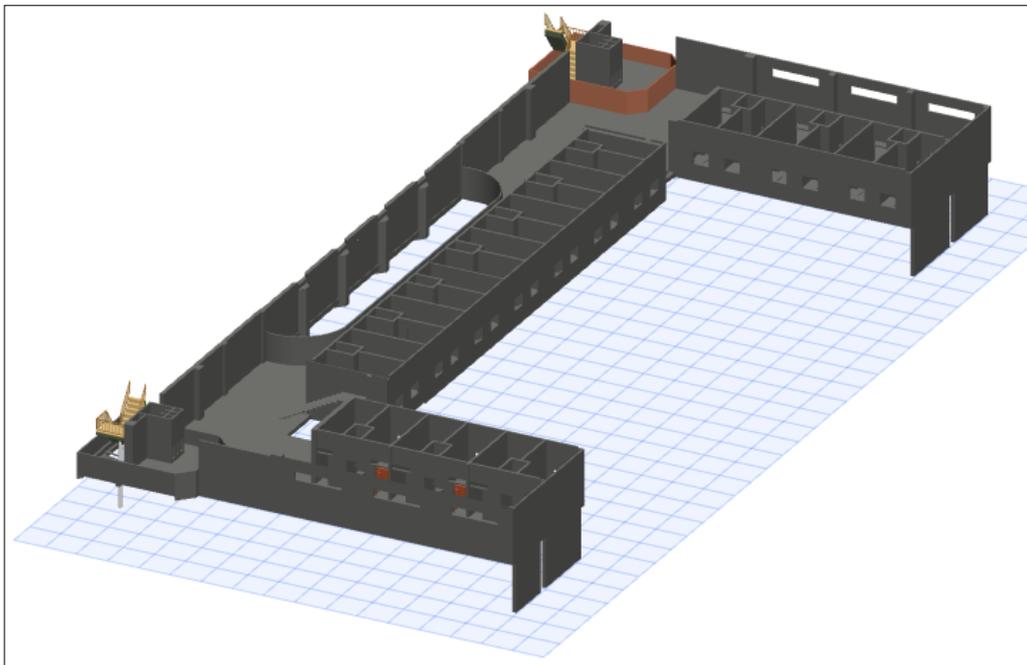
Alzado lateral de planta N+3.96 en 3D
